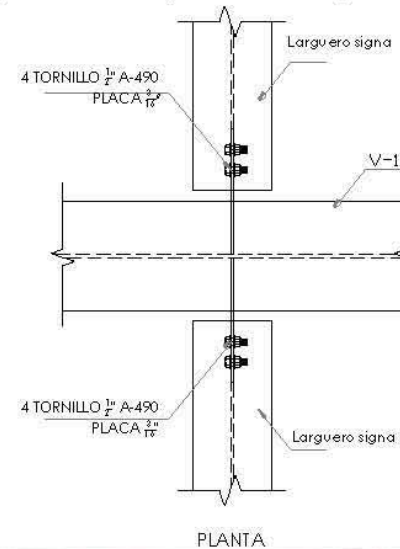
del sistema constructivo vigas IR y largueros sigma
